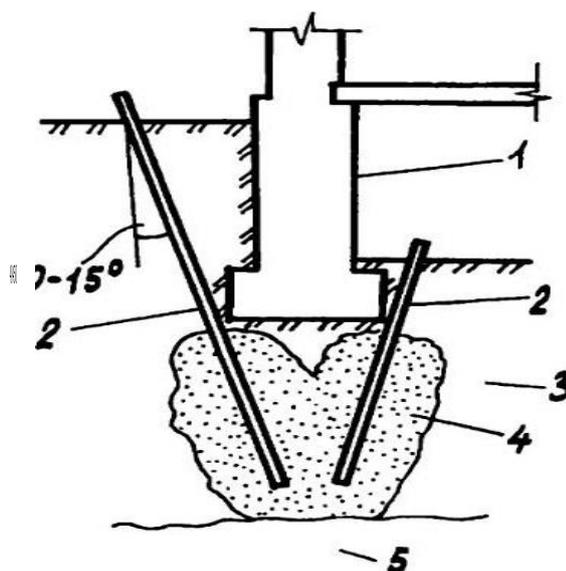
Схема закрепления грунтов с помощью инъеции растворов: 1 – фундамент; 2 – иньектор; 3 – слабый грунт; 4 – укрепленный грунт; 5 – плотный грунт
